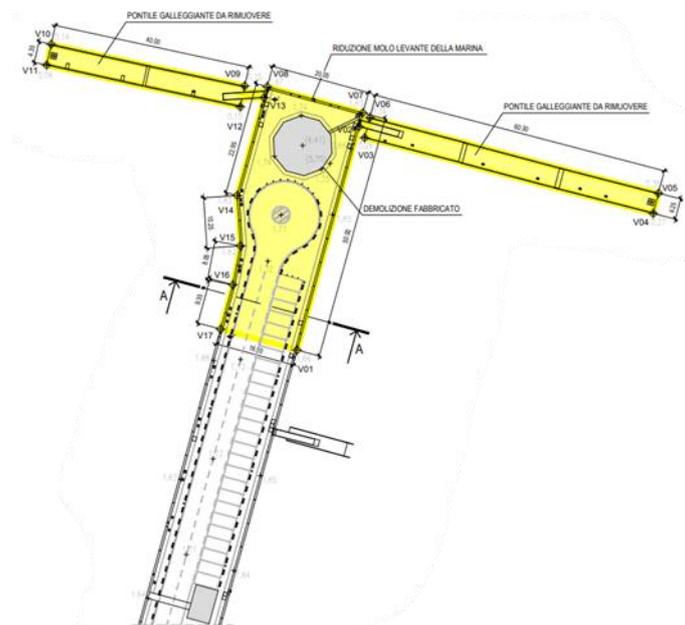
Planimetria del molo di levante con indicazione delle aree da demolire
